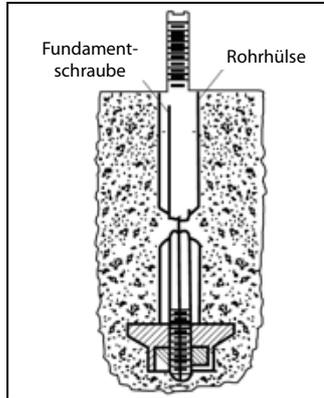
Ankerschraube (Fundamentschraube)
